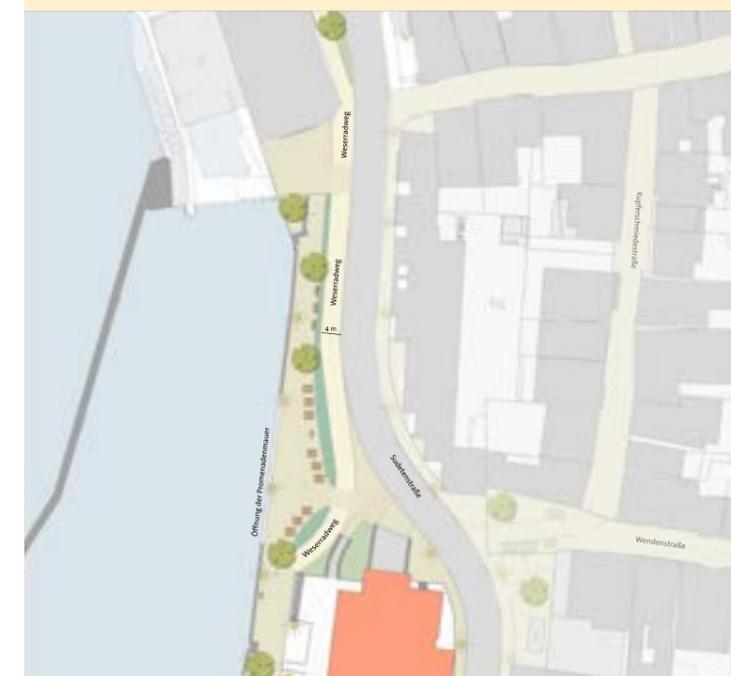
Entwurf einer möglichen Umgestaltung des „Langer Walls“. Darstellung: Stadt Hameln.
